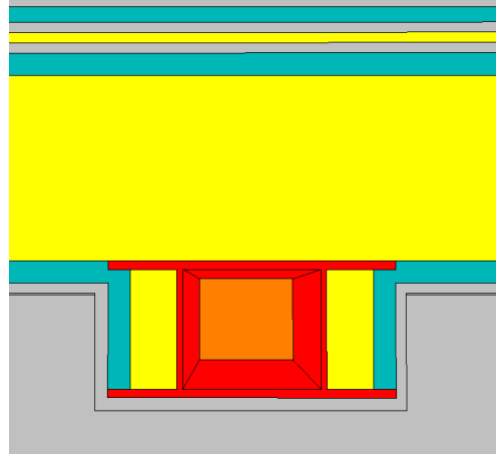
Trisco : coupe de détail dans les poutres métalliques
